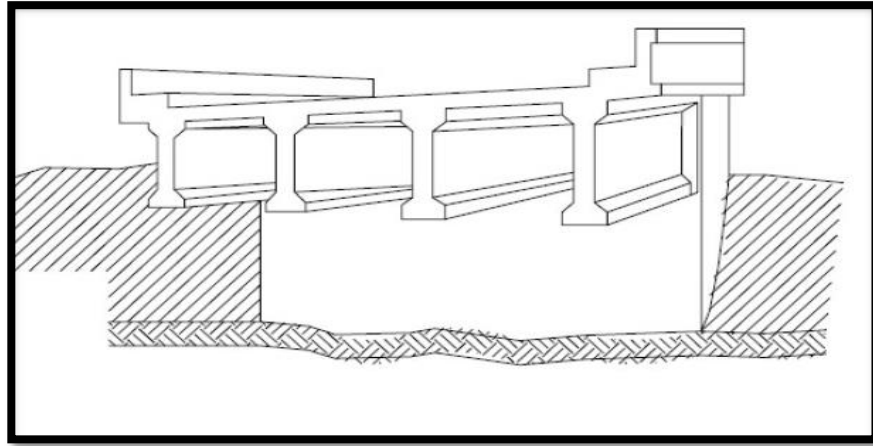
Puente de losa con viga en concreto Pretensado.
